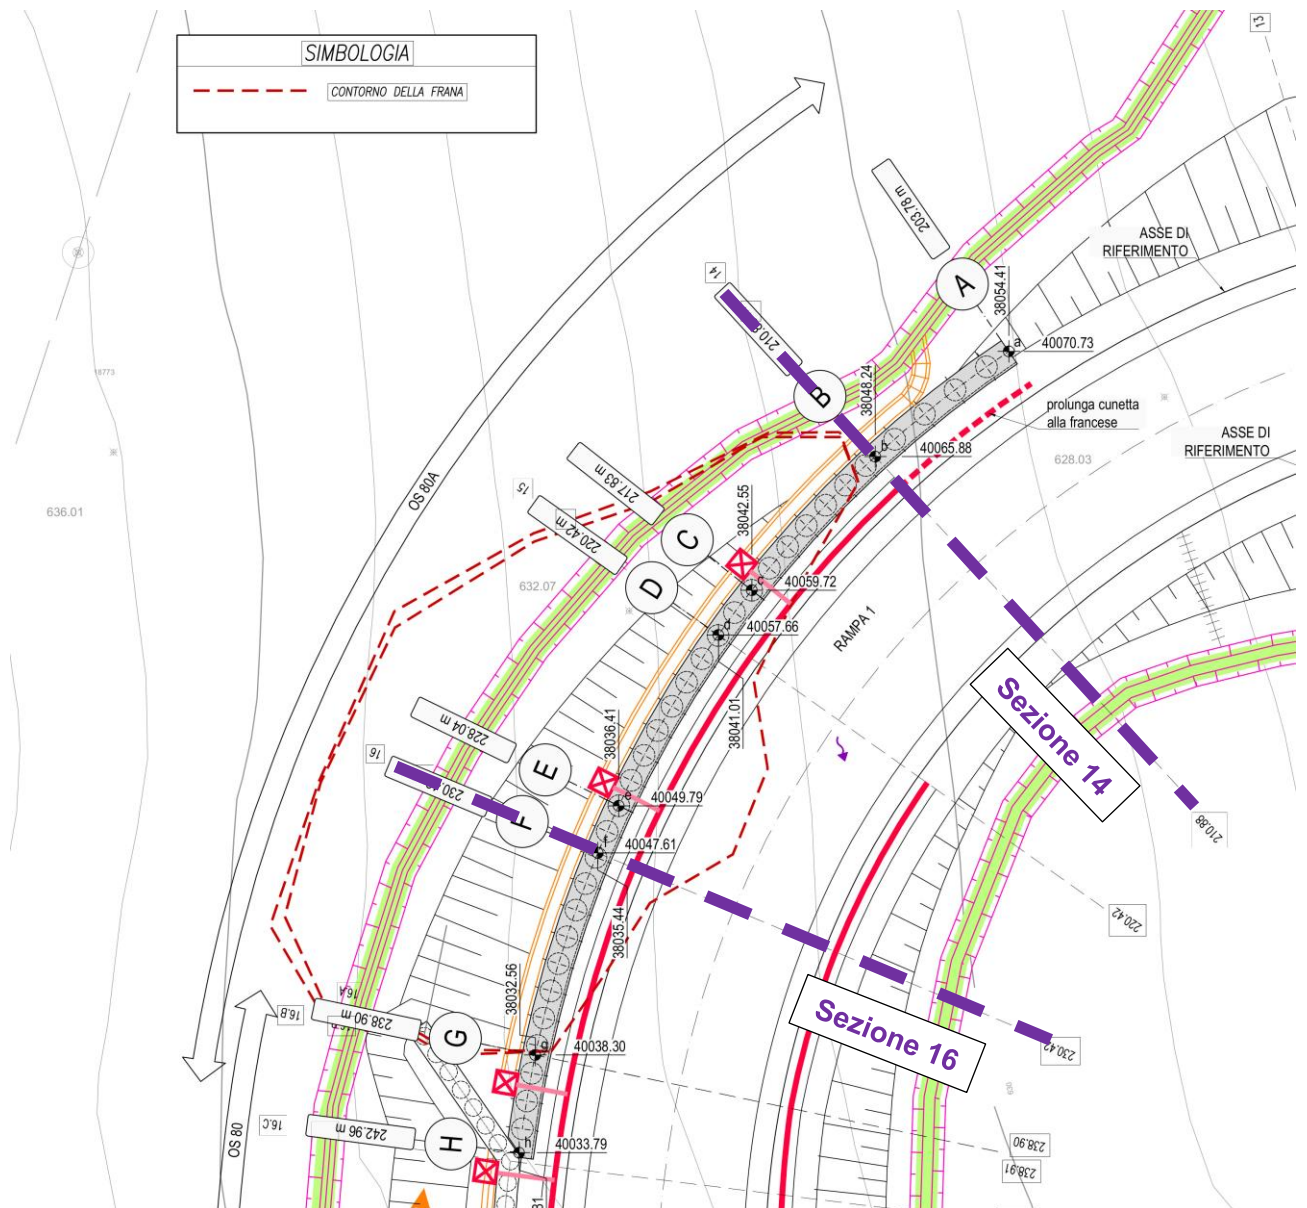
Planimetria intervento con indicazione delle sezioni di calcolo
